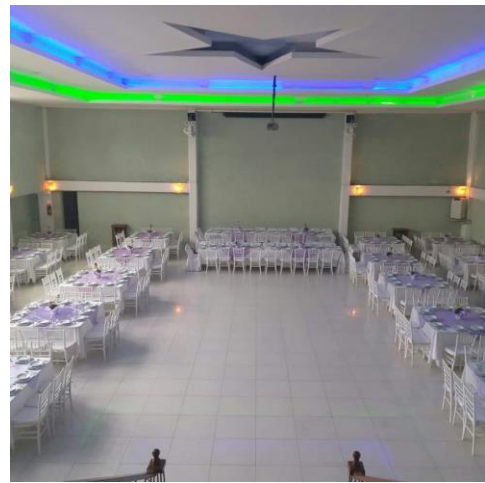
y 28. Trabajo terminado salón principal. Autoría propia
